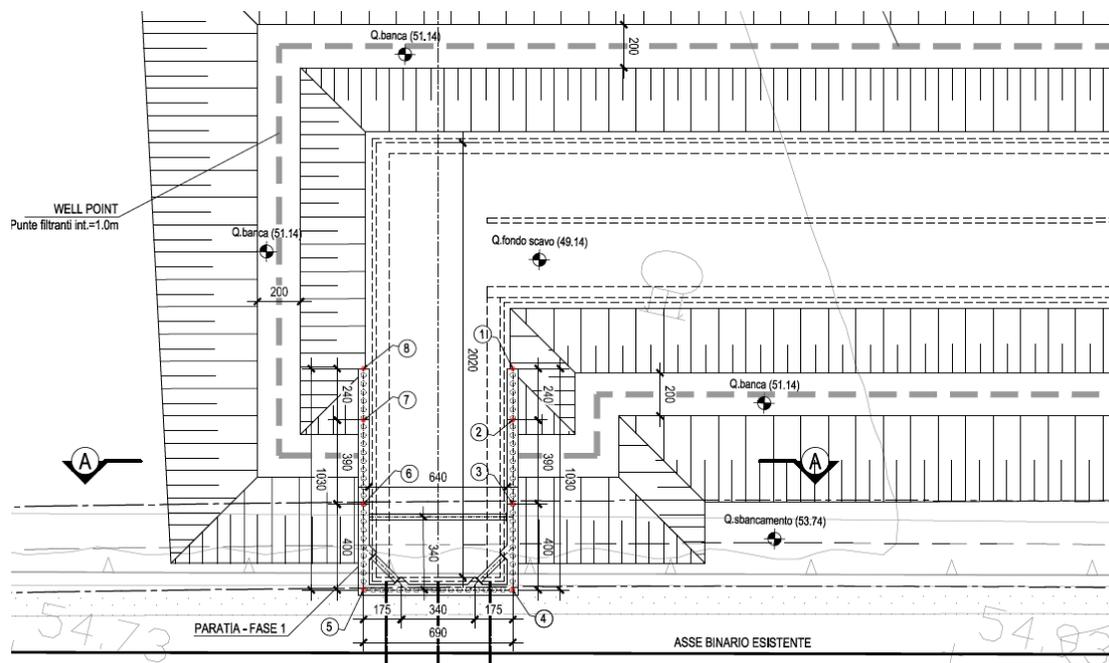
SOTTOPASSO IN07 – PLANIMETRIA PARATIA E SCAVI PE (FASE 1)
